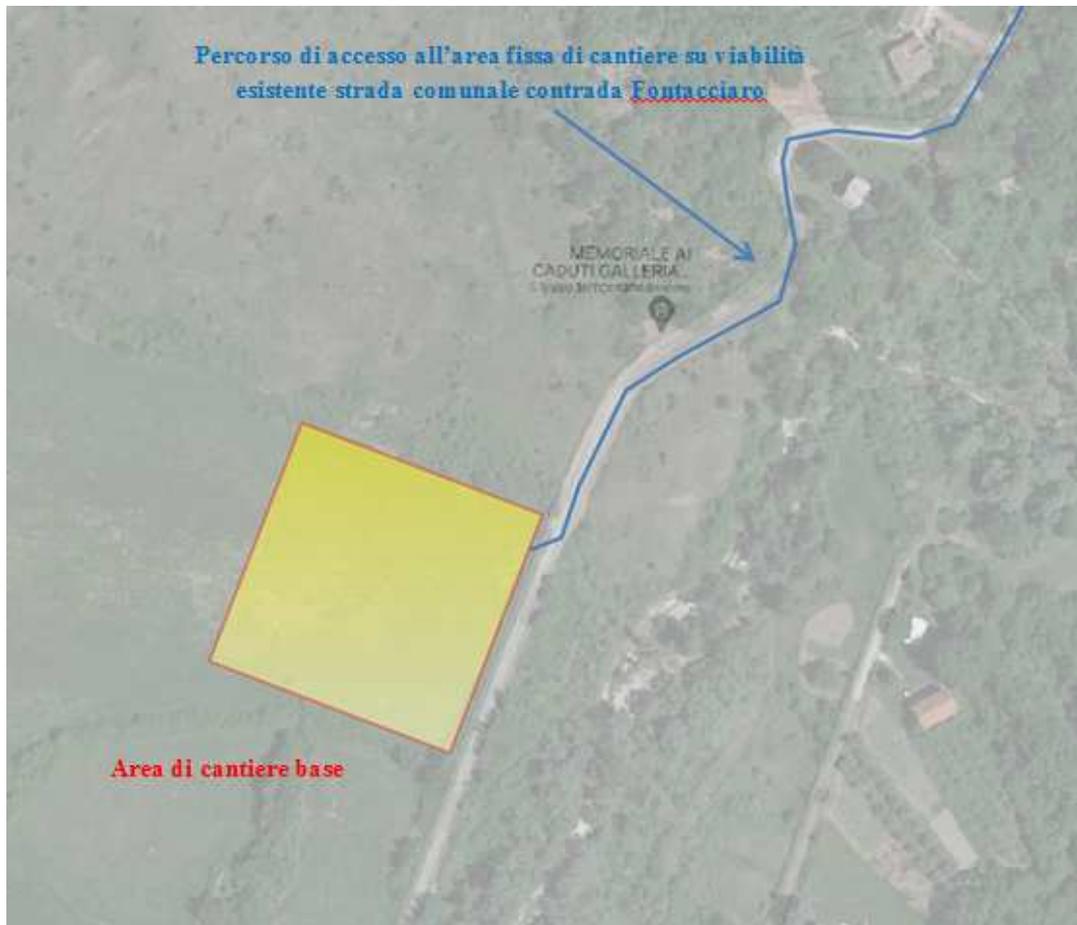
Localizzazione Cantieri Base N.2 (Potabilizzatore) - Stralcio 3
